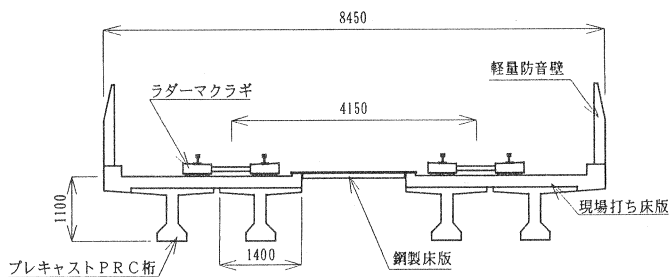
プレキャストP.R.CダブルT桁高架橋概略断面図
